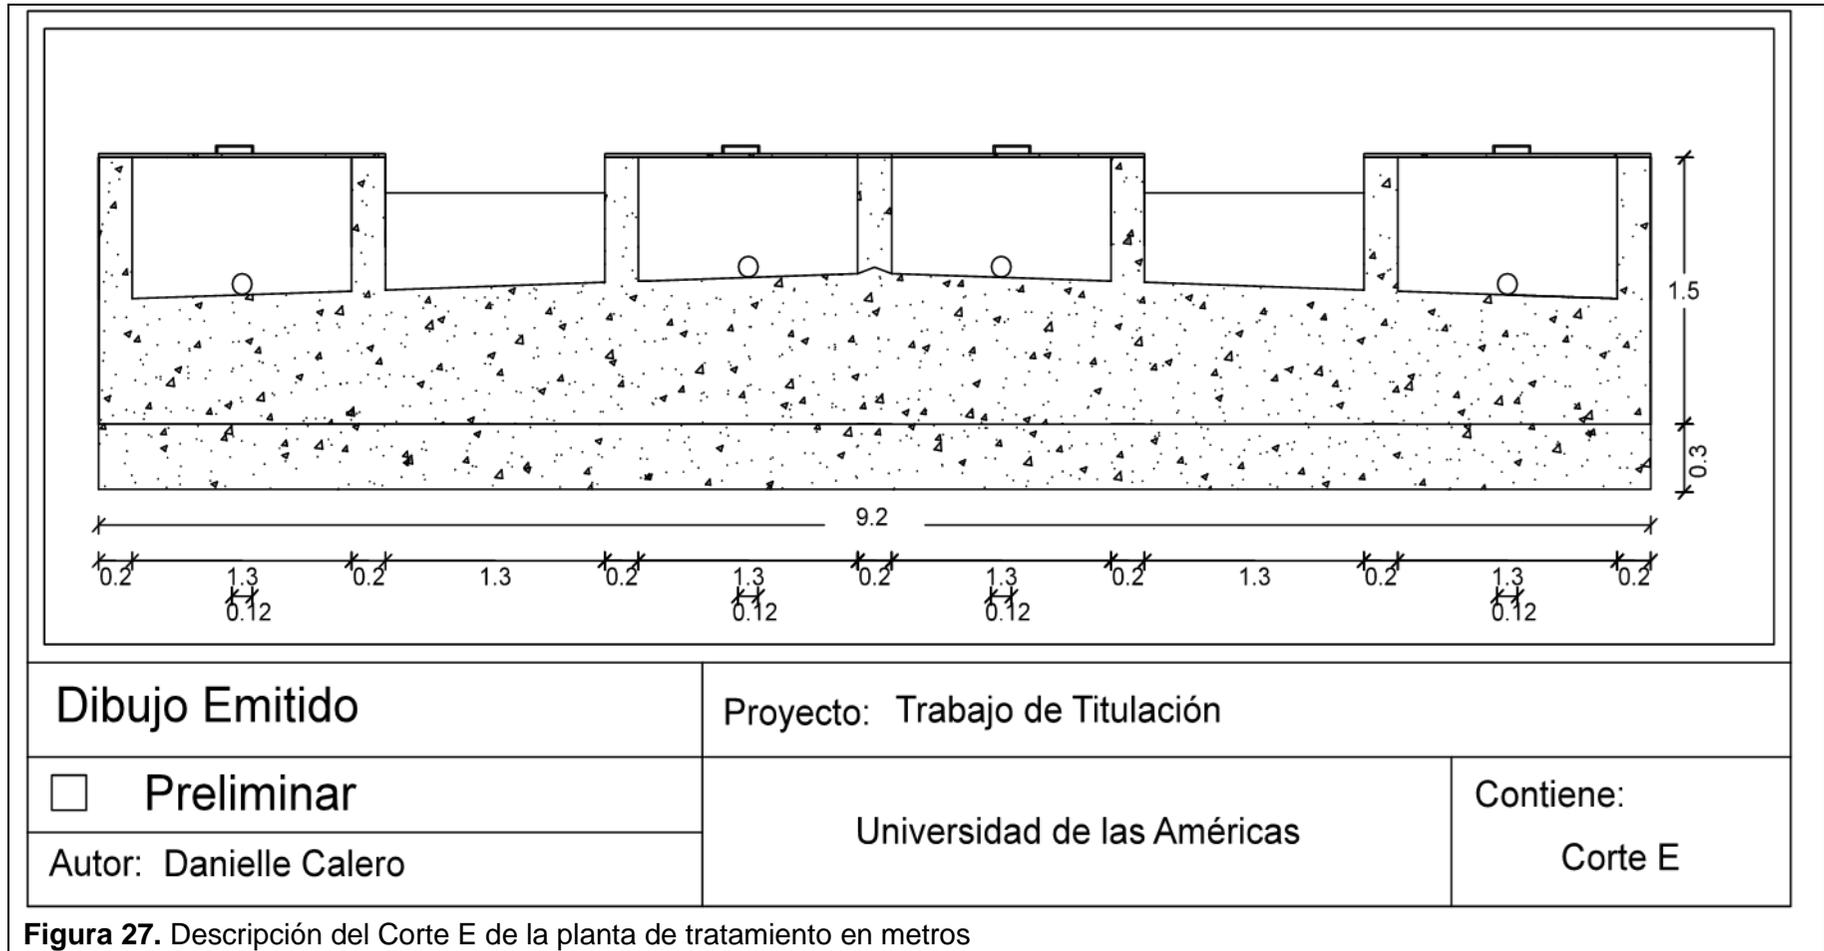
Descripción del Corte E de la planta de tratamiento en metros
